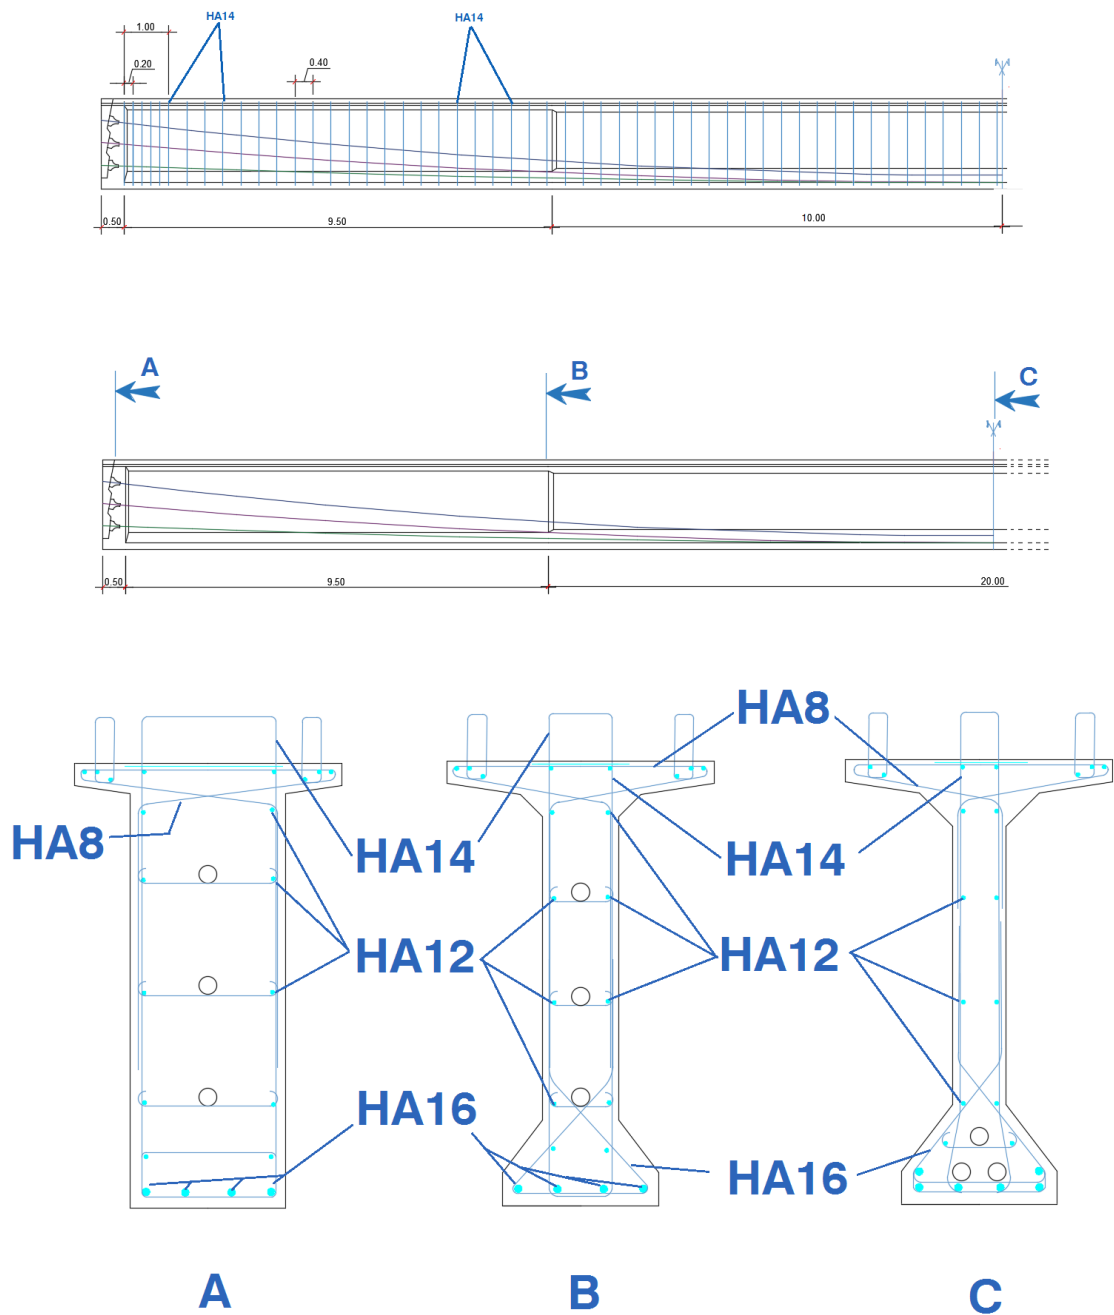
Ferrailage de la poutre(AutoCAD).
